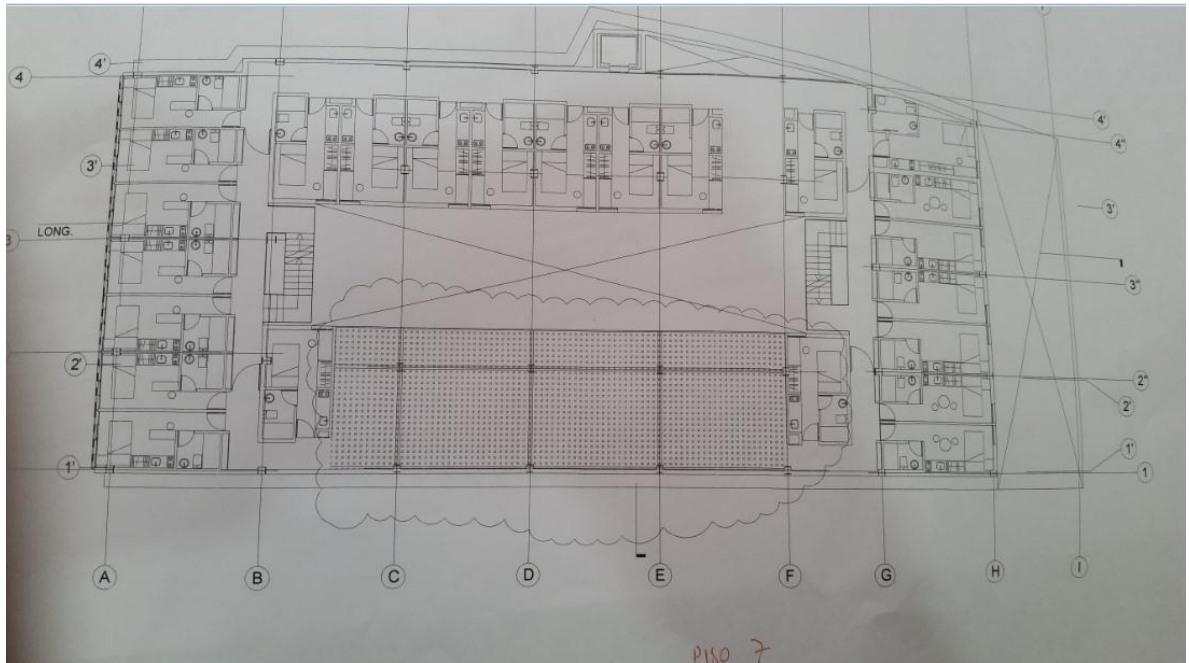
PLANO ARQUITECTÓNICO DEFINITIVO – AP02bind IMPRESO.
